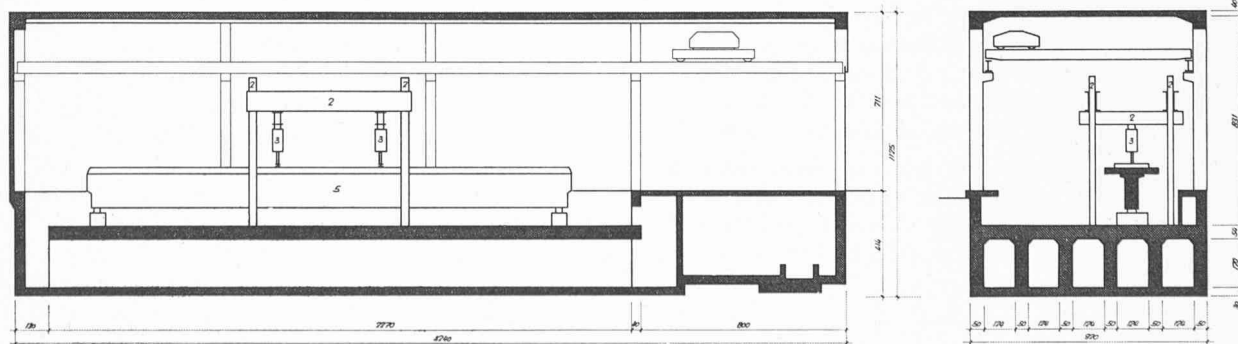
Elévation et coupe du laboratoire (légende, voir fig. 1).
